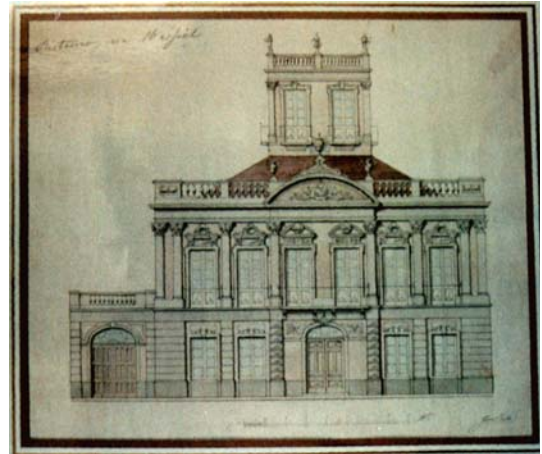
Fachada da casa 02 da Pça. Cel. Pedro Osório. Fundo rosado, pilastras acinzentadas ou azuladas. Foto Natália Naumova.
